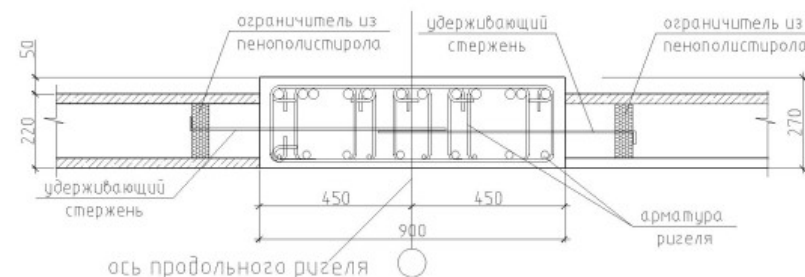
Узел опирания сборных плит перекрытия на монолитный ригель посредством шпонки.
